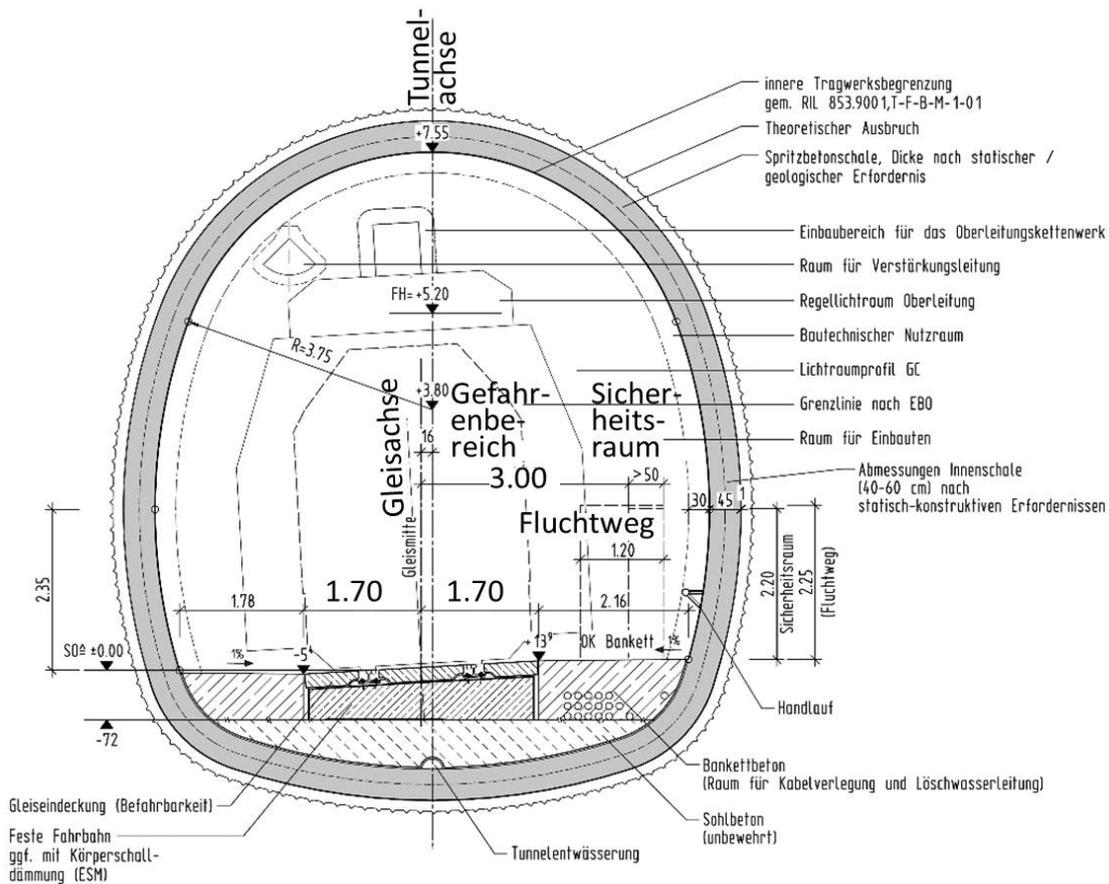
Beispiel für den Querschnitt eines Tunnels in Spritzbetonbauweise (Neue Österreichische Tunnelbauweise, NÖT)
